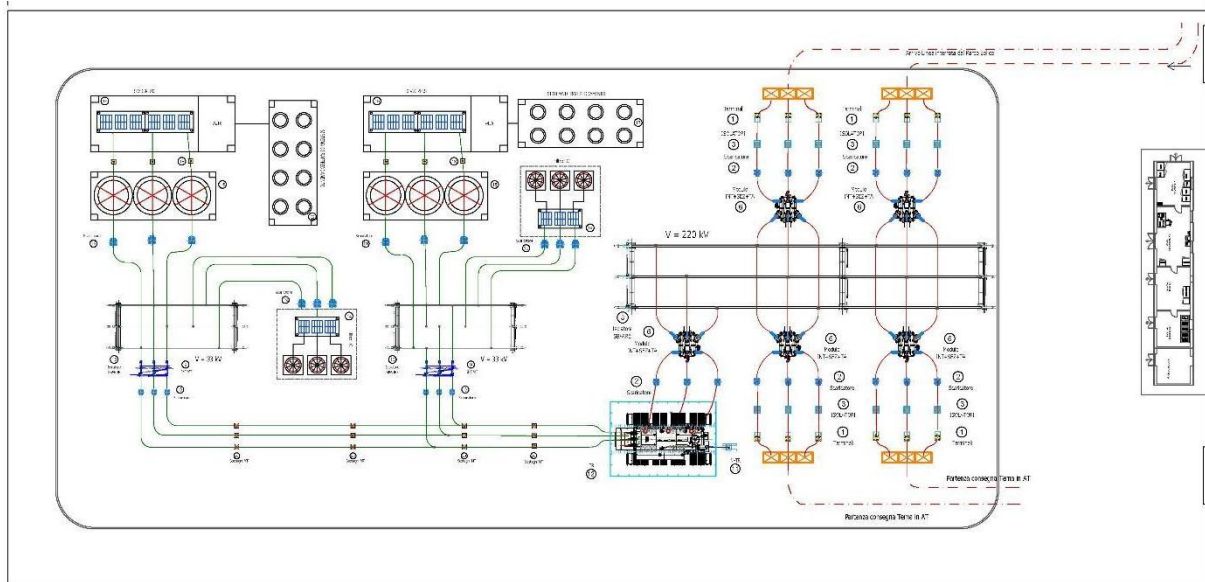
Schema planimetrico della Sottostazione di misura e consegna
